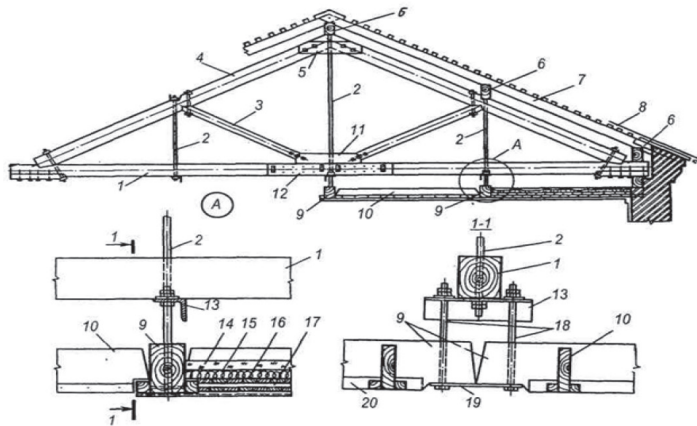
Металодерев'яна ферма з підвісним горіщним перекриттям:
